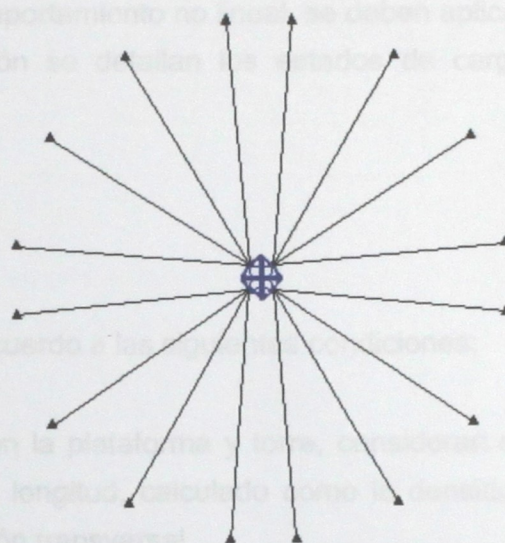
Planta de la disposición general de los anclajes en el Multiflotador
